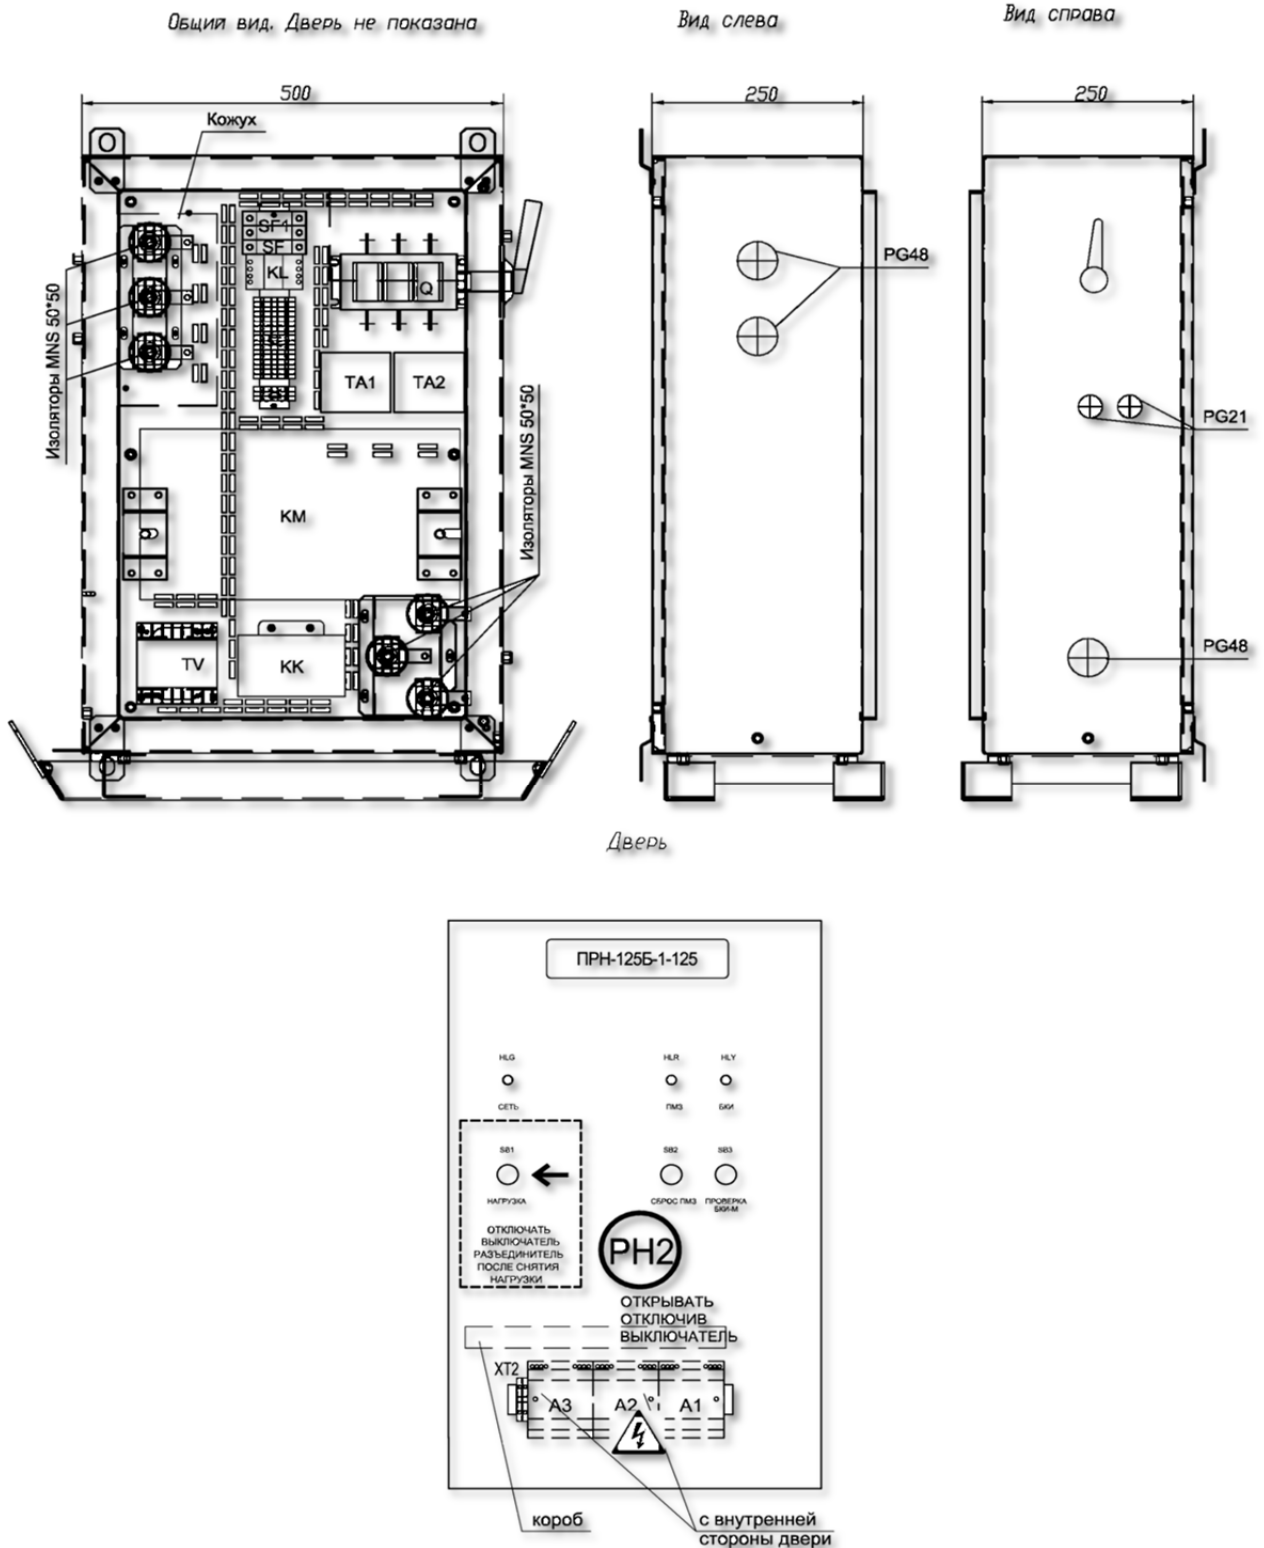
Общий вид ПРН с габаритными размерами
